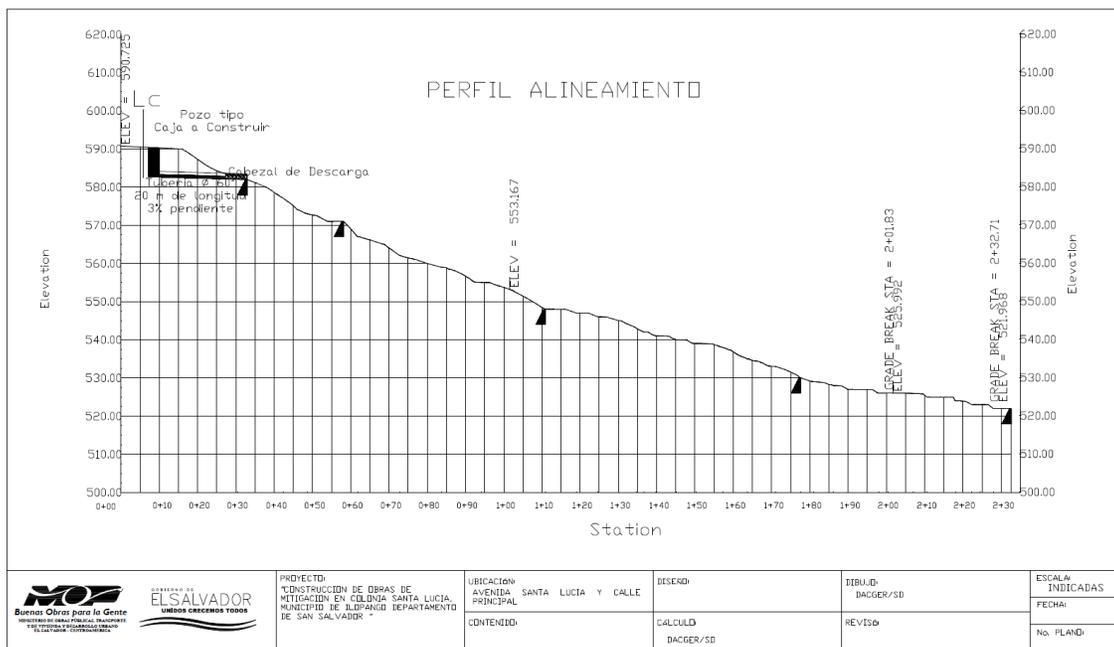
Obras en el sector donde se desviarán las aguas lluvias que comprende: pozo, 20 m de tubería, cabezal de descarga y muros guardanivel.
